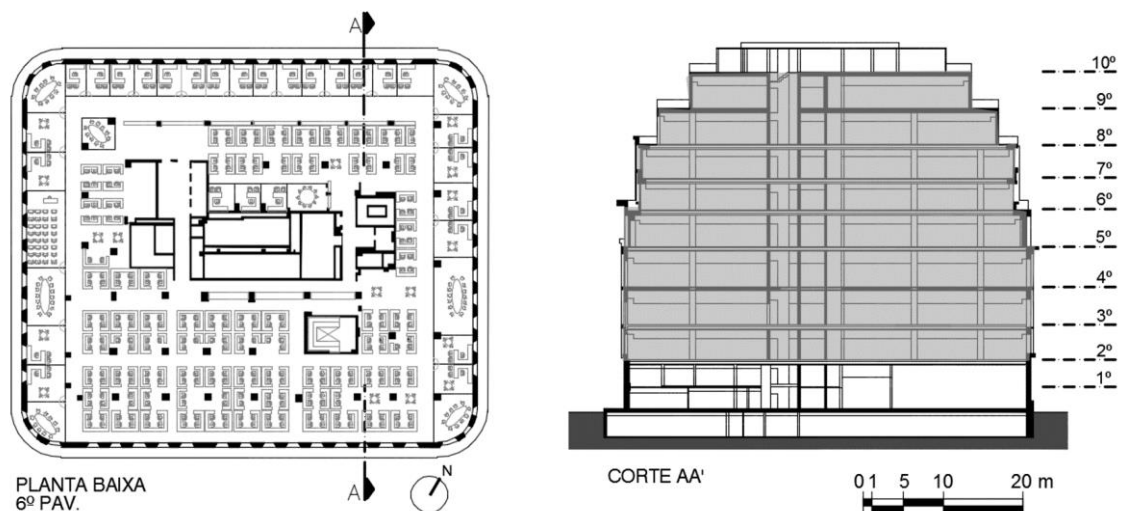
Reabilitação do ed. Galeria: planta e corte (em cinza: pavimentos de escritórios). Fonte: adaptado de Ecotech (2011).
